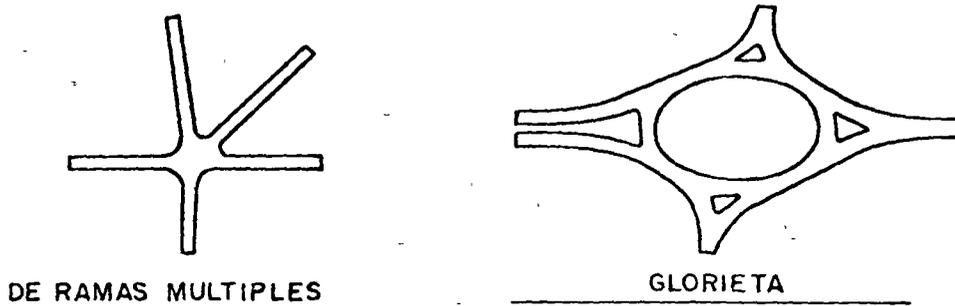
TIPOS GENERALES DE ENTRONQUES A NIVEL
